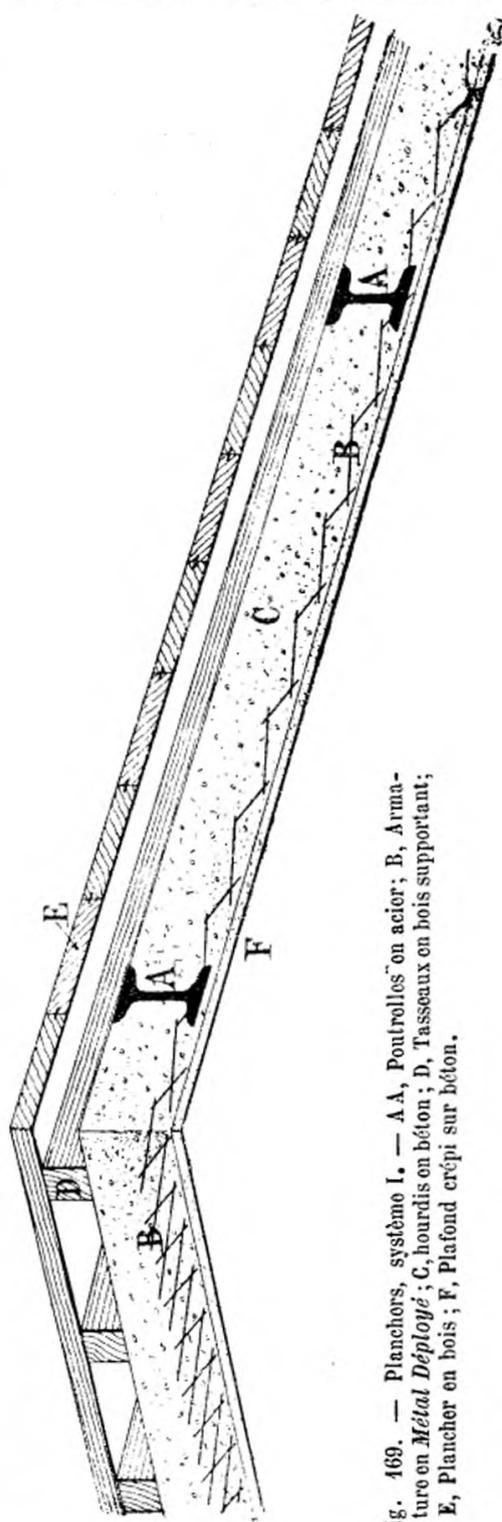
Planchers, système I. — A A, Poutrelles en acier; B, Armature en Métal Déployé; C, hourdis en béton; D, Tasseaux en bois supportant; E, Plancher en bois; F, Plafond crépi sur béton.
